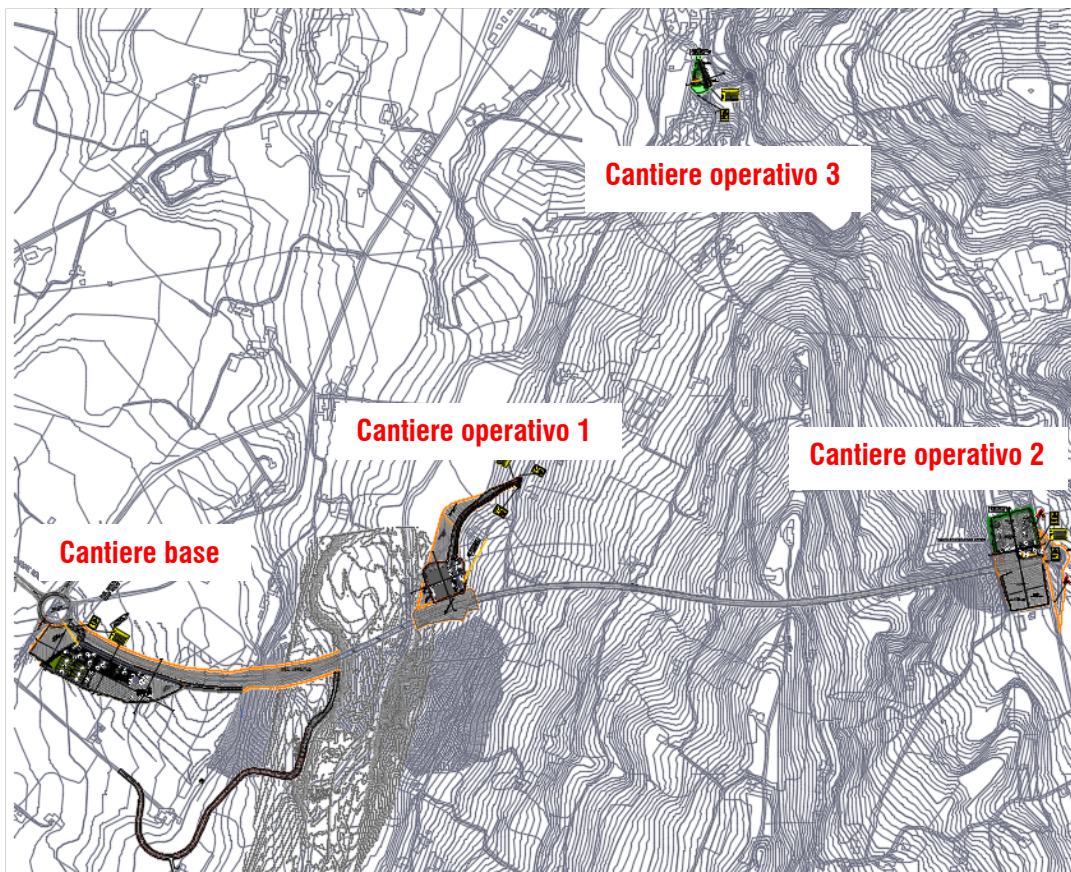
Planimetria con le aree di cantiere estratto dalla tavola di progetto
